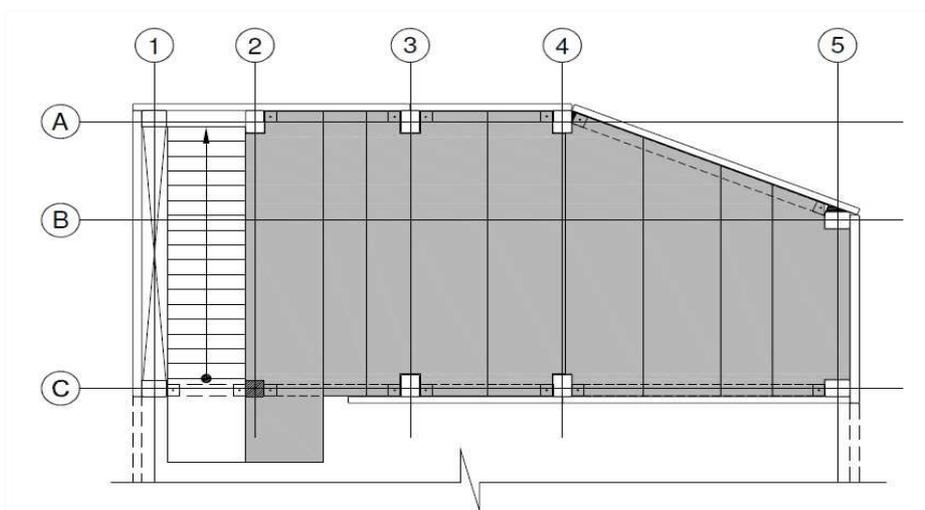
Exemplo de modulação de um pavimento com lajes alveolares (PETRUCELLI, 2009)
